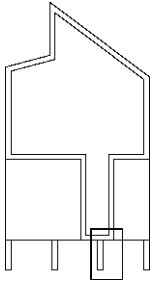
| Fassadenschnitt Hand|Werk|Raum. M1:75.
